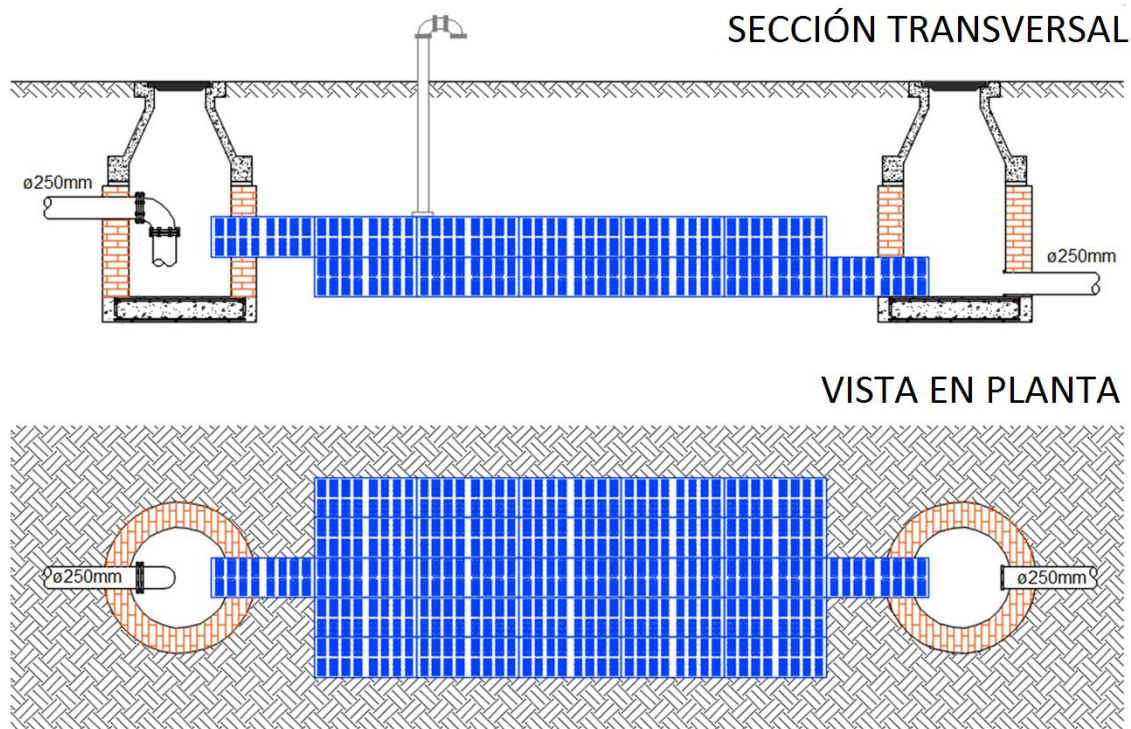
Esquema depósito de retención modular entre pozos de registro en planta y alzado.
